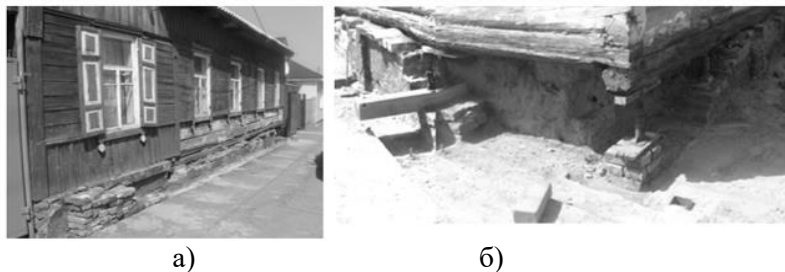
Заміна фундаменту дерев'яного будинку:
